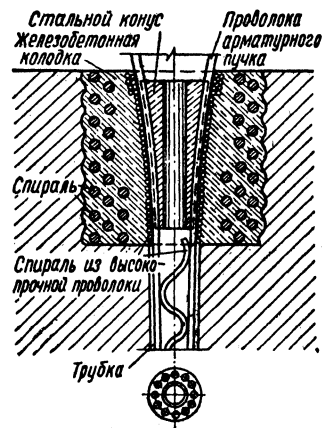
Анкеровка арматурного пучка железобетонной колодкой и стальной пробкой.
